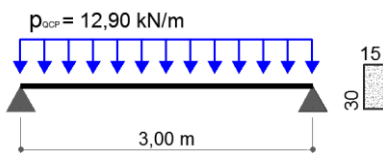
Geometria e carregamento das vigas VB-fck
